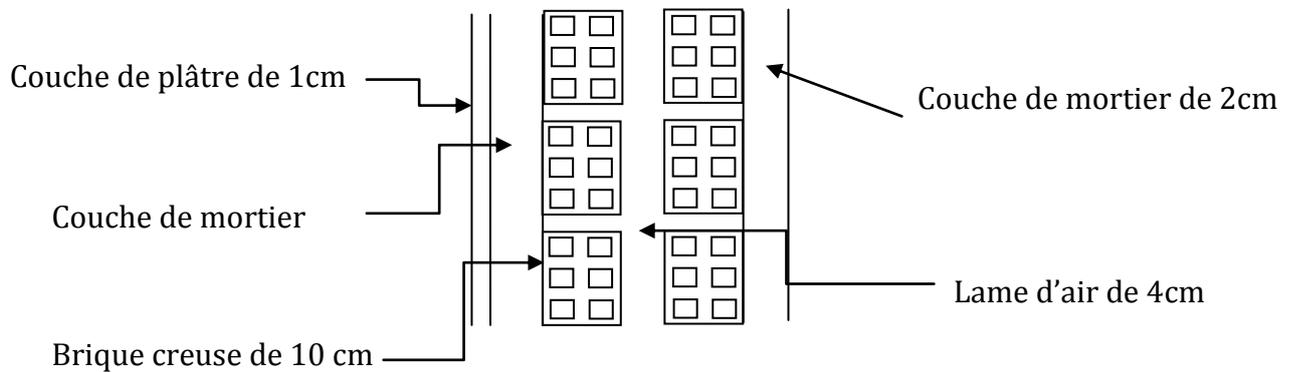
Coupe transversal d'un mur double parois en brique creuse.
